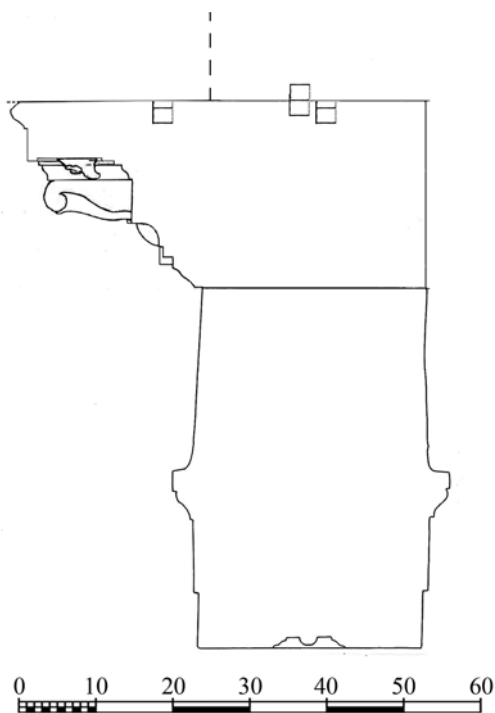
Sezione della trabeazione dell'edificio (disegno autore).
